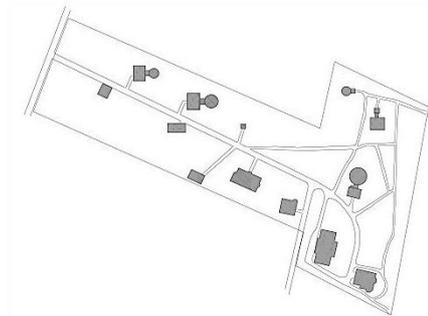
Planta esquemática de observatorio descompuesto y distribuido en un espacio.
